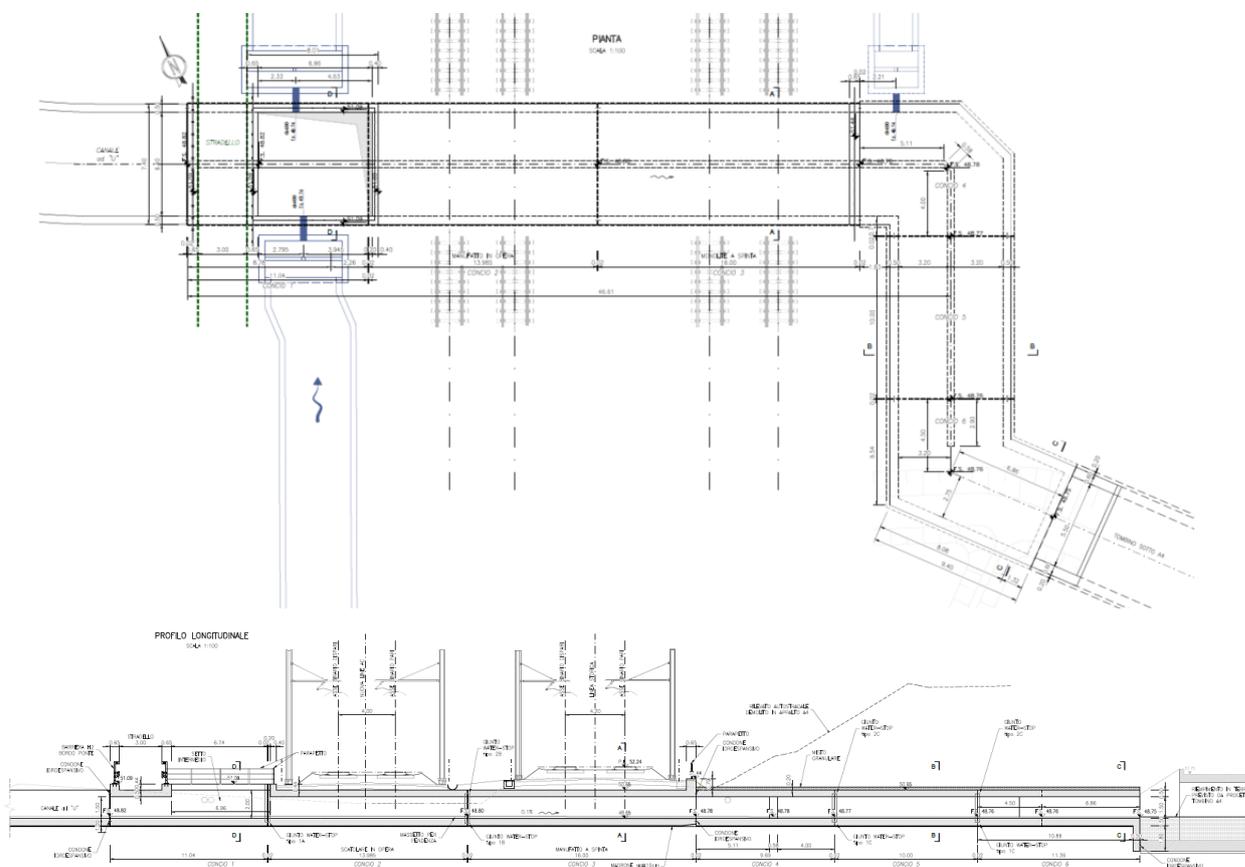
Pianta e profilo del doppio scatolare di progetto
